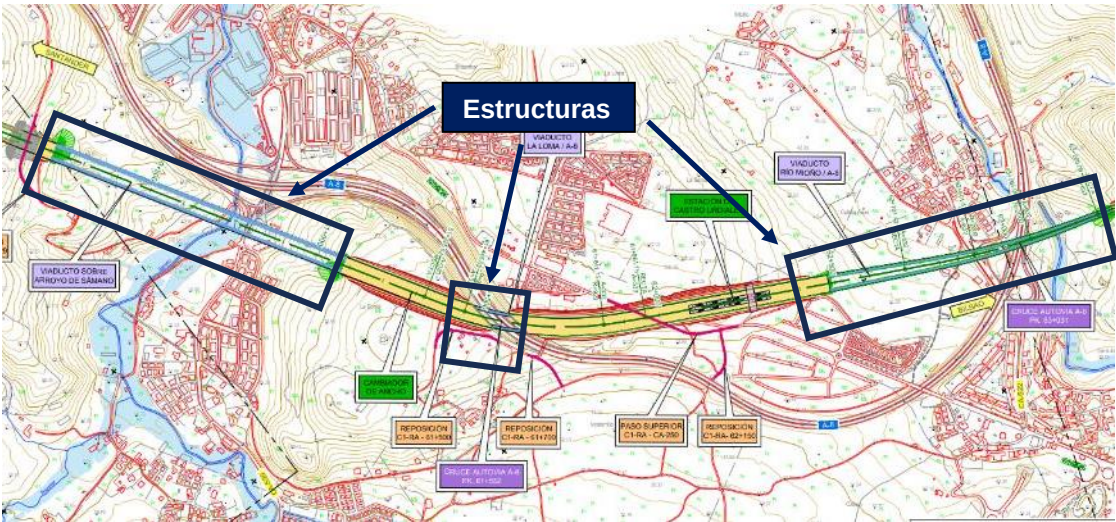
Trazado de alternativa Rasante Alta. Detalle de estructuras
